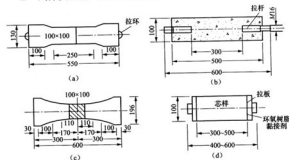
混凝土轴向拉伸试件及埋件 (单位: mm)
